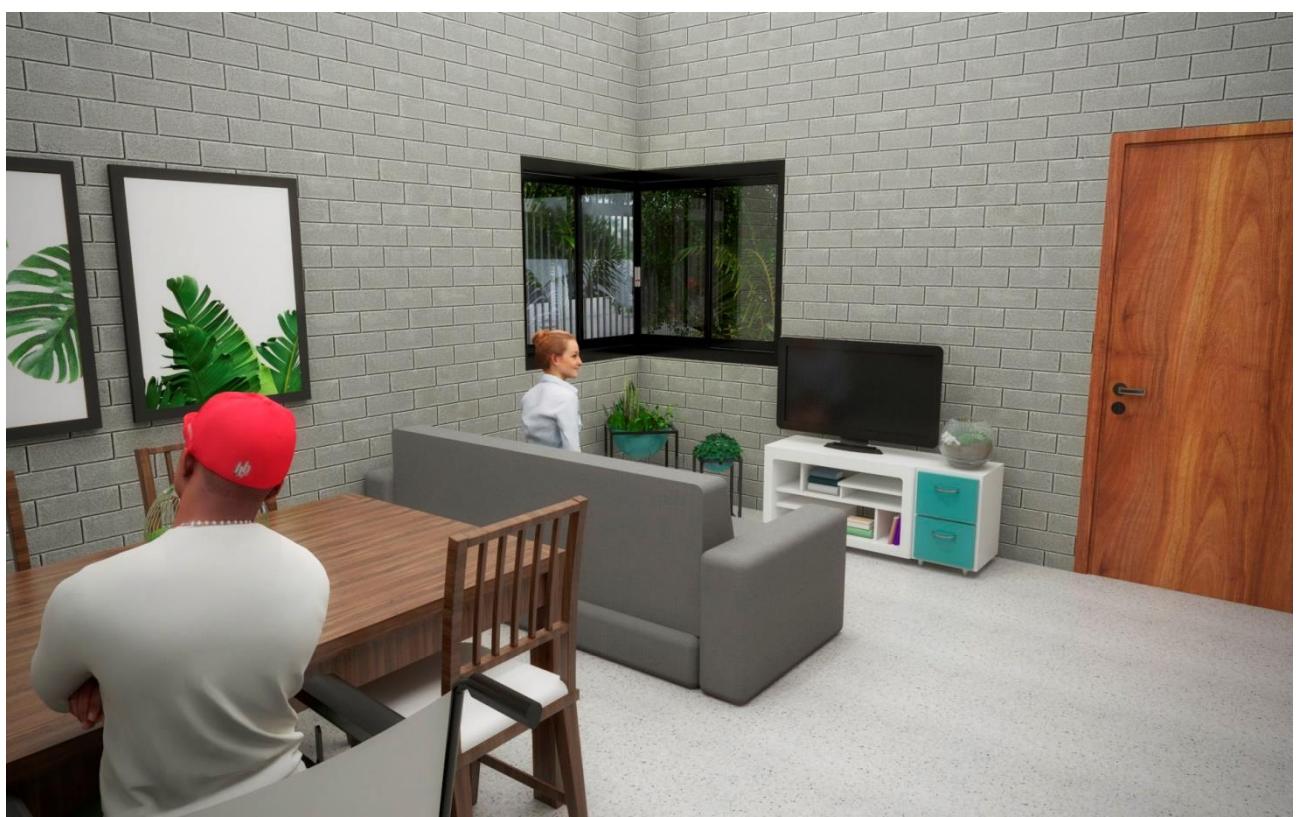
Perspectiva da Sala – Planta tipo A. Fonte: Produzido pelo autor.
